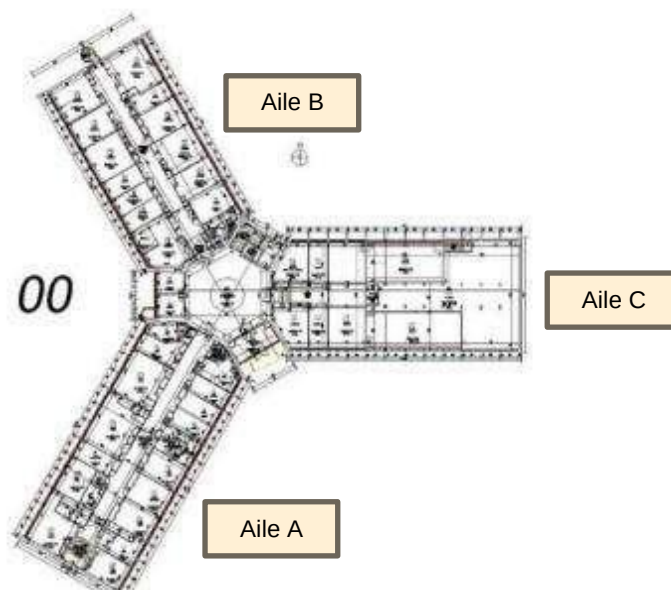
Vue en plan RDC du Tripode, avec la rotonde centrale
